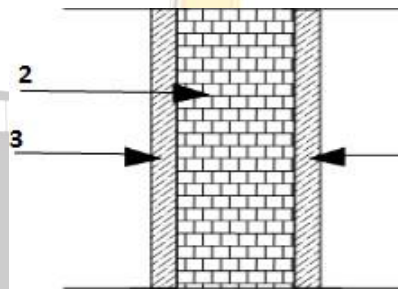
Coupe transversale du mur en simple cloison
